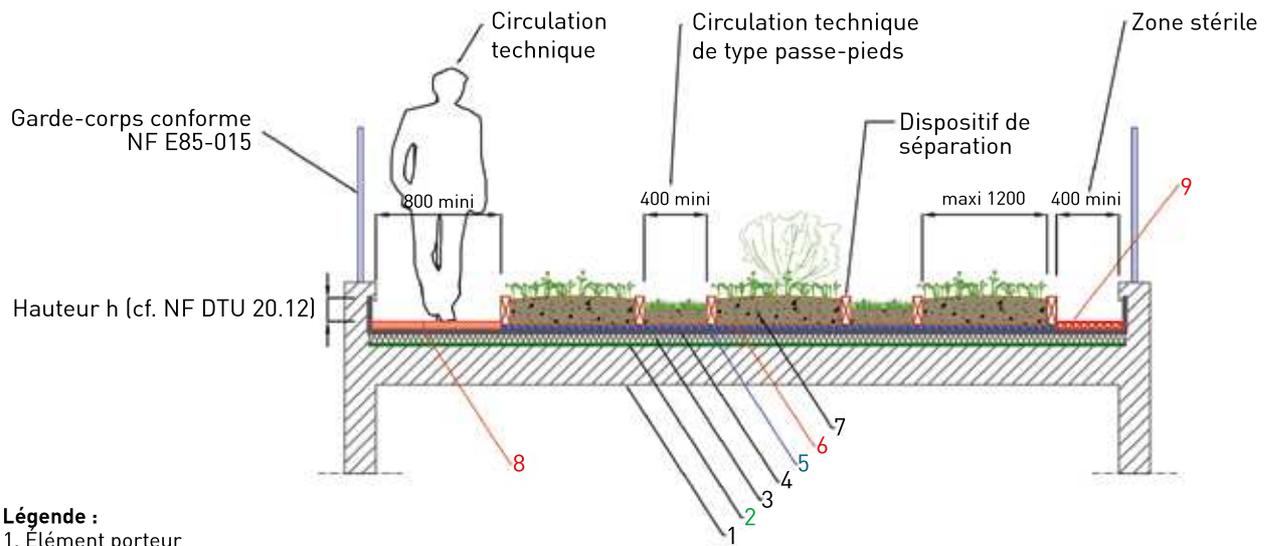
Coupe de principe de plates-bandes de toiture-terrasse accessible au public
